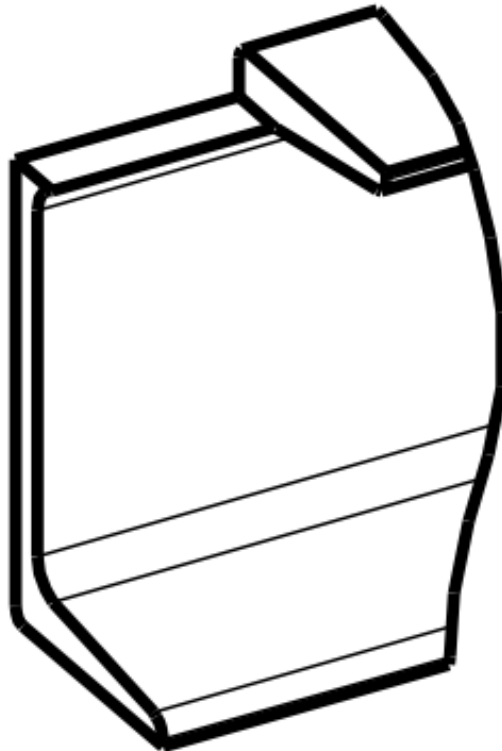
Vista de corte isométrica de ala de vigas de acero A36 UPN 80
